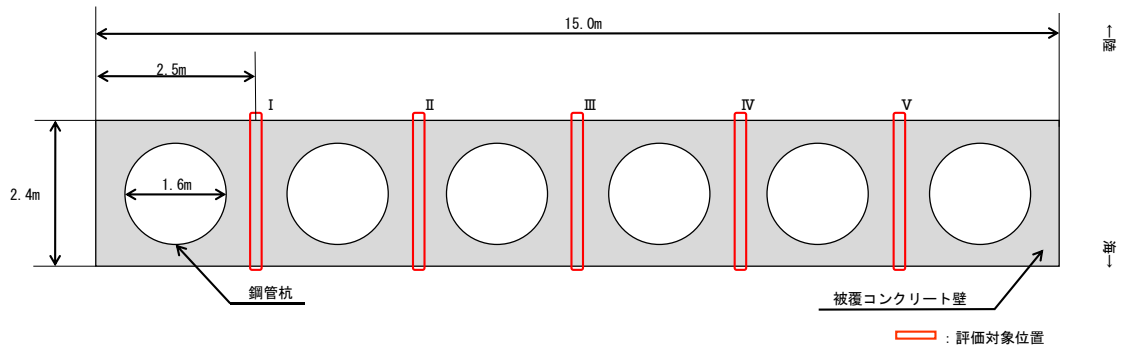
(1) 評価対象位置図(②-②断面, 平面図)
